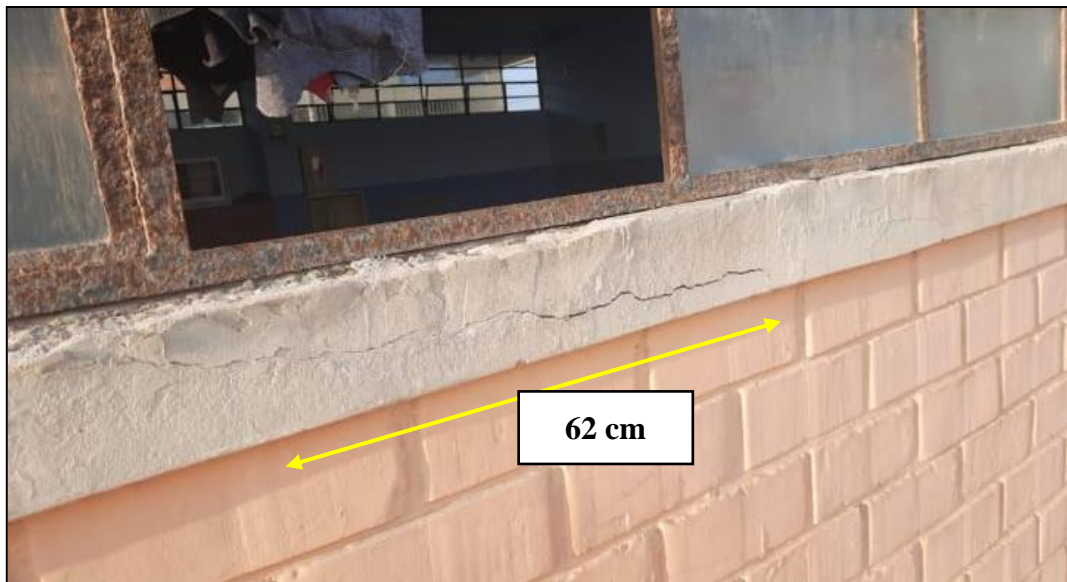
Agrietamiento de la viga solera – Primer Nivel
